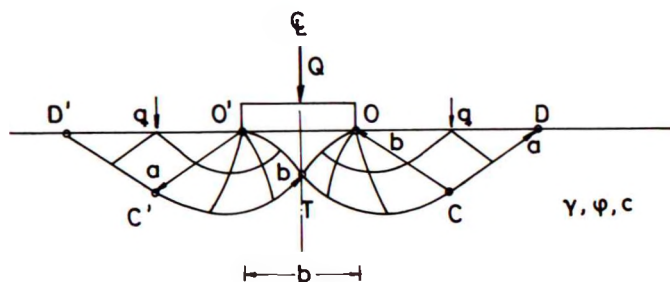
A: Brudfigur for bæreevnen af lodret og centralt belastet stribefundament på jordoverfladen.
